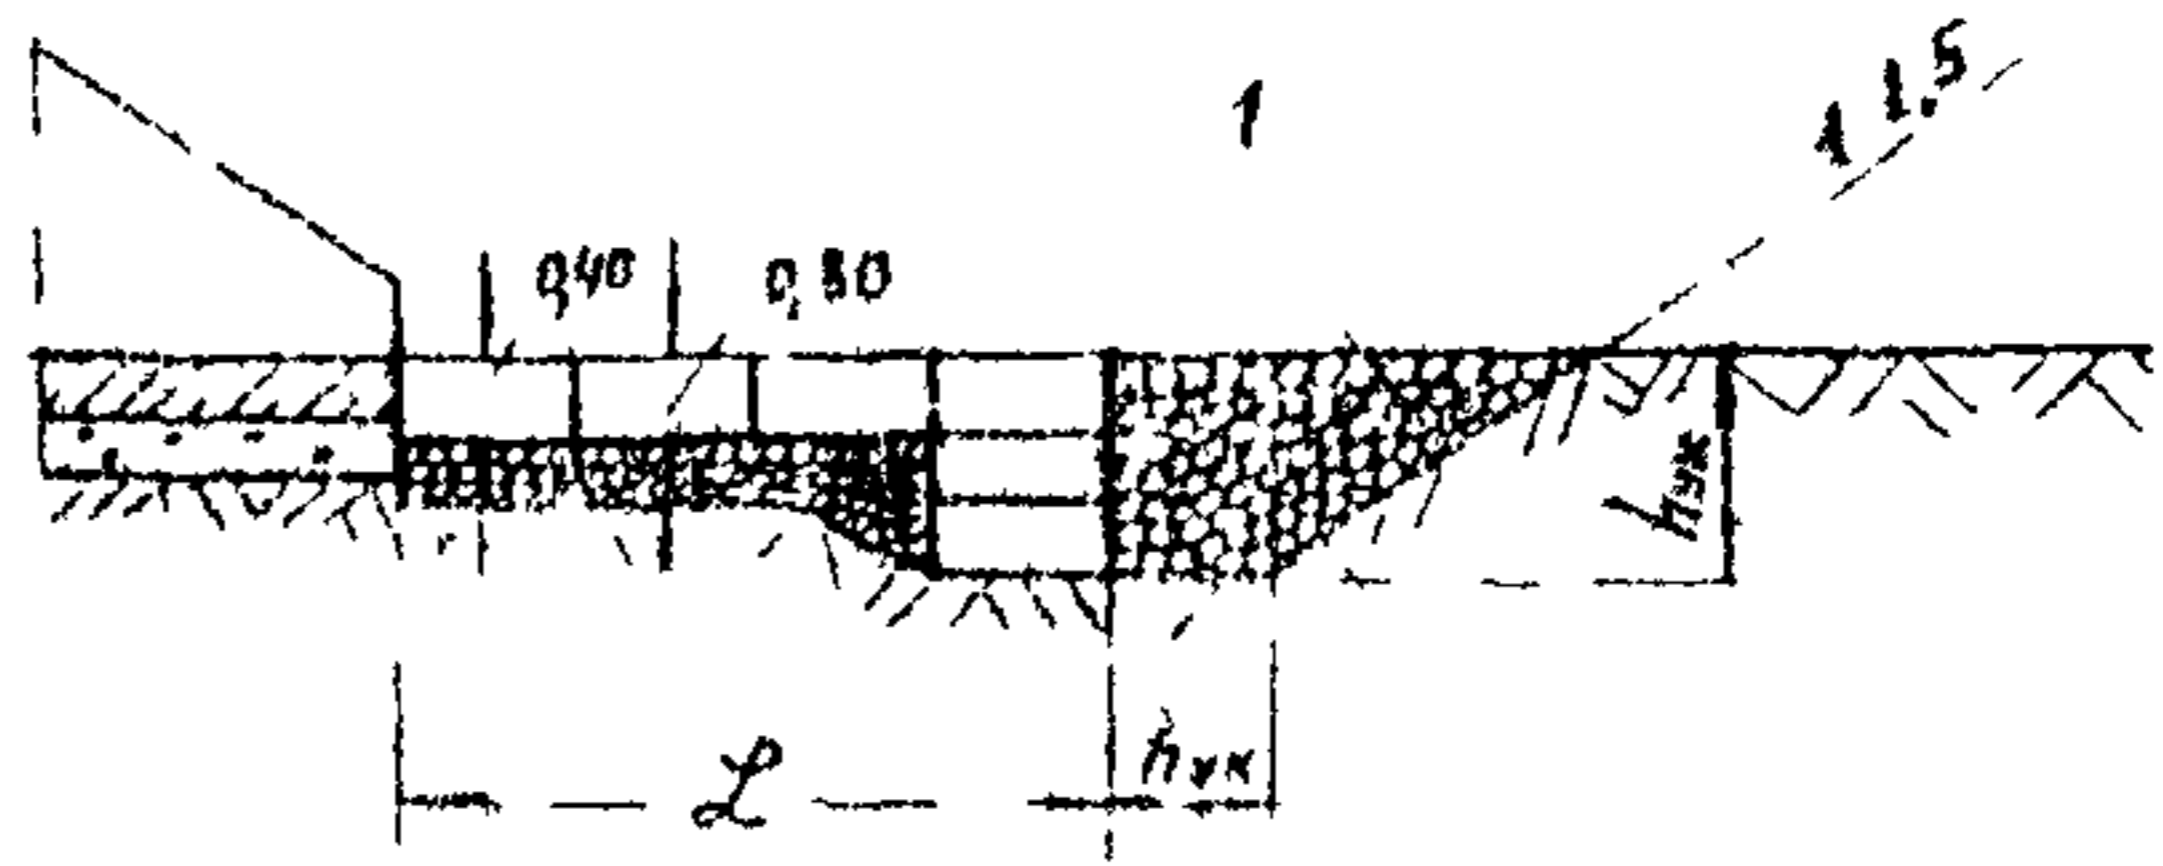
Схема выходных дуэел с укреплением из бетонных блочков;
